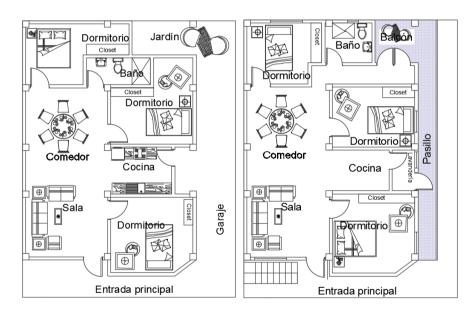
Plano arquitectónico P.A.V.2 Fuente: Propia
